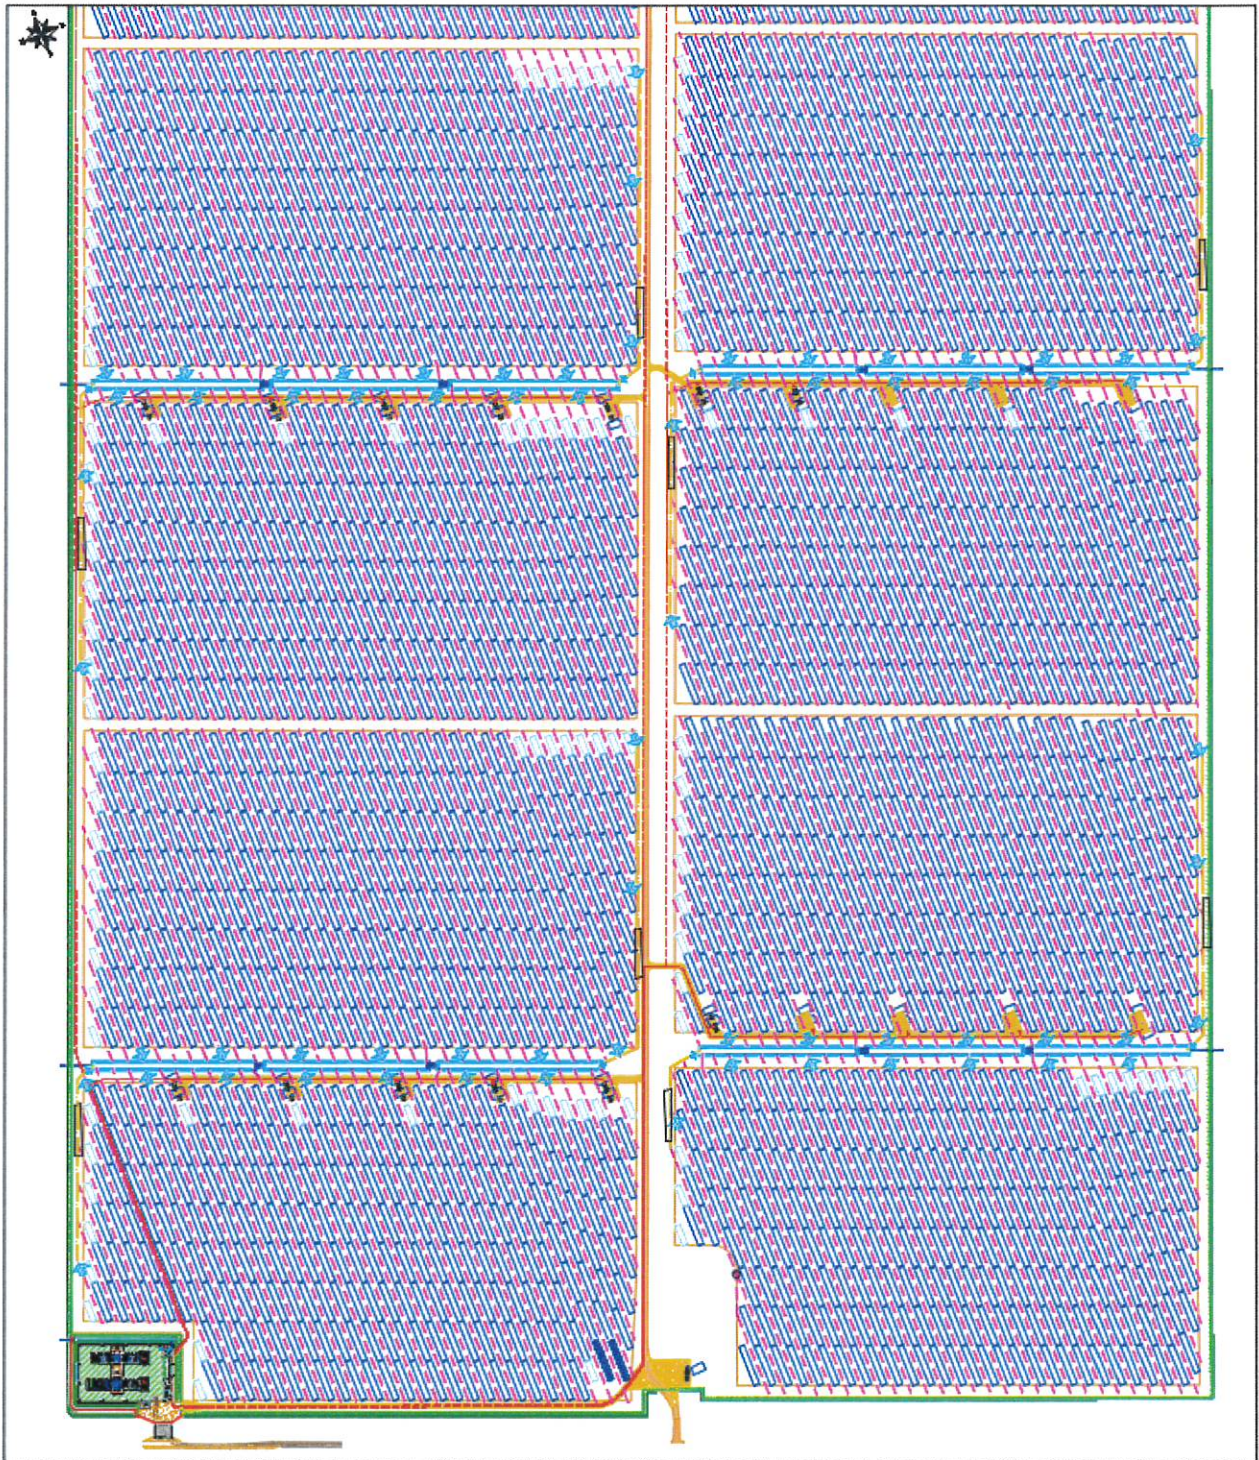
Layout impianto agrivoltaico e sistema di drenaggio – Parte centrale
